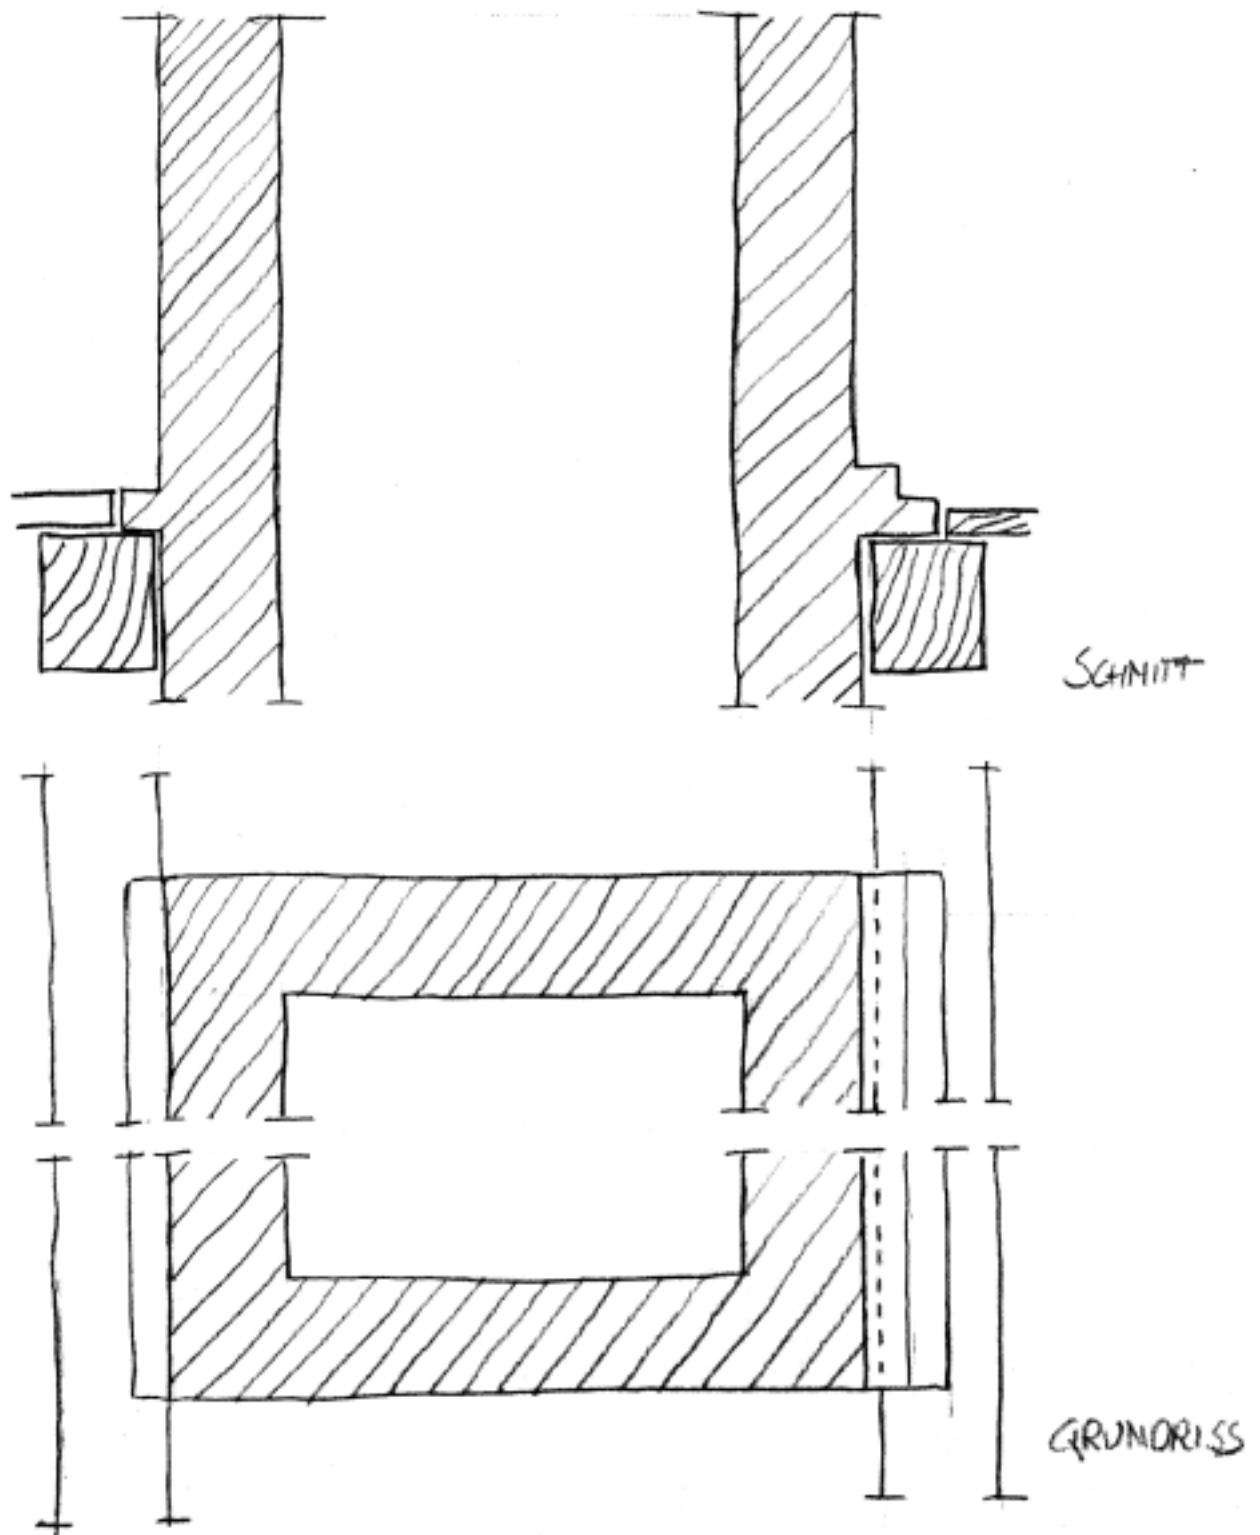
Skizze, Grundriss und Schnitt. Durch überkragende Steinschichten wurden Lasten auf die Deckenbalken übertragen
